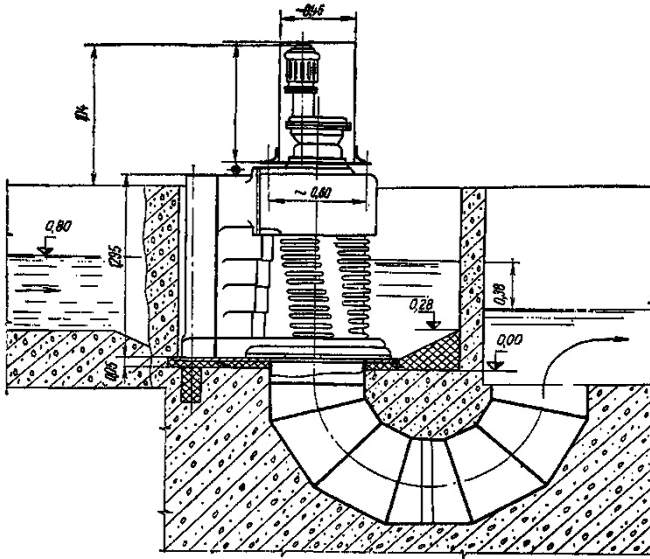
Схема установки решіток дробарки РД – 600 при подачі стічних вод на очисні споруди
